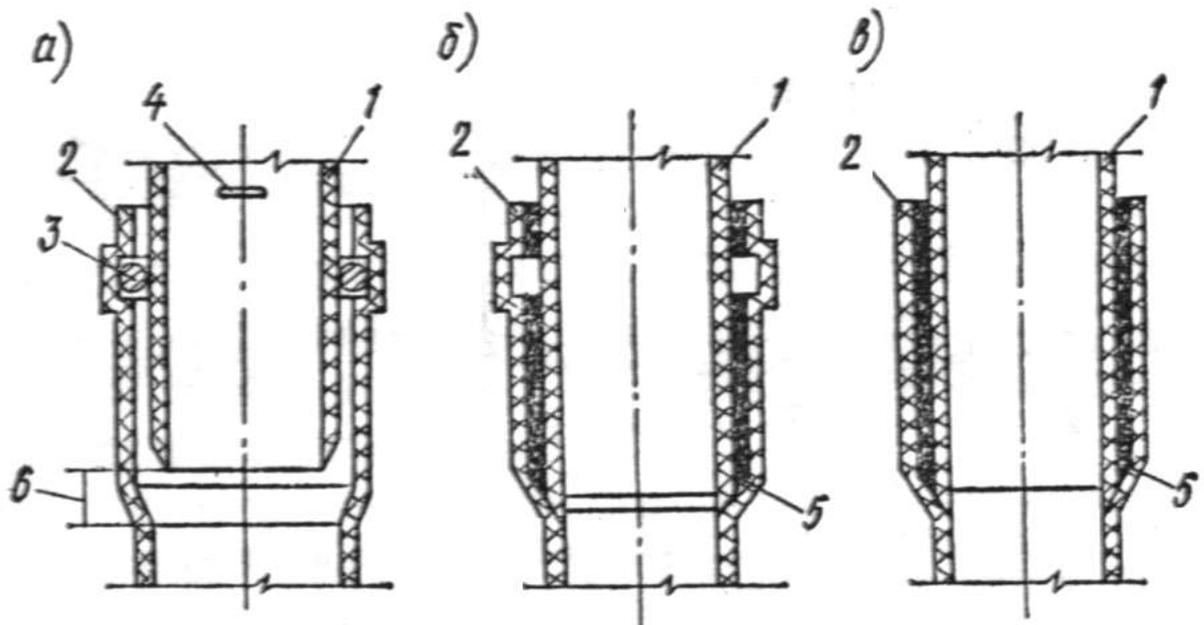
Соединение труб из ПВХ с резиновыми кольцами (а) и клеевые (б и в):
